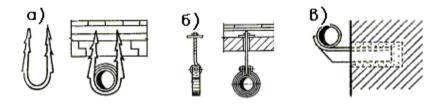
Средства крепления трубопроводов: a - хомут; 6 - подвеска; e - кронштейн
